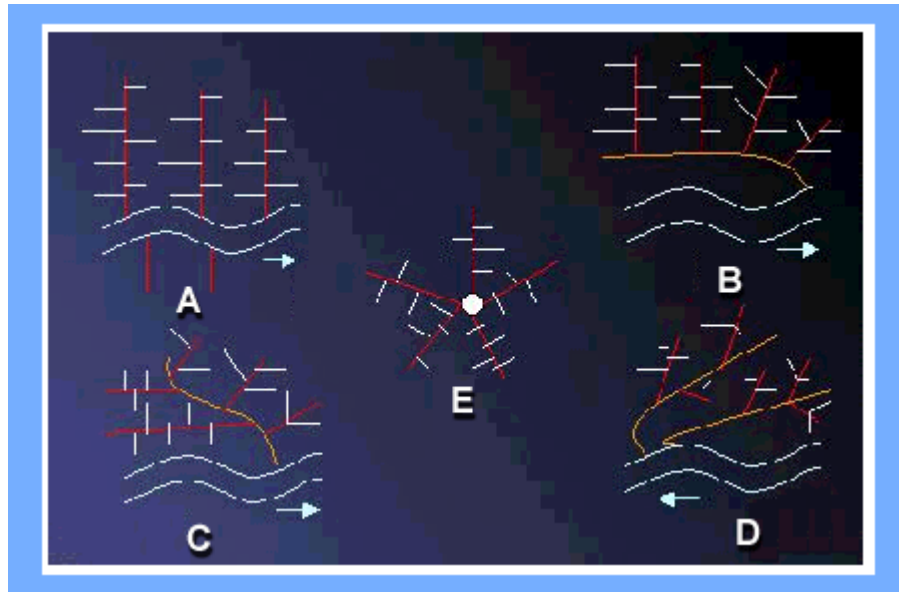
Tipos de canalización. Metcalf & Eddy (1992:148).
